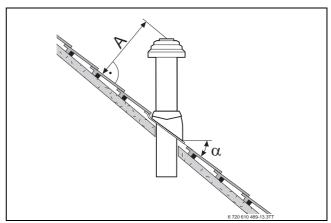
Abstandsmaße und Dachneigungen bei Schrägdach
